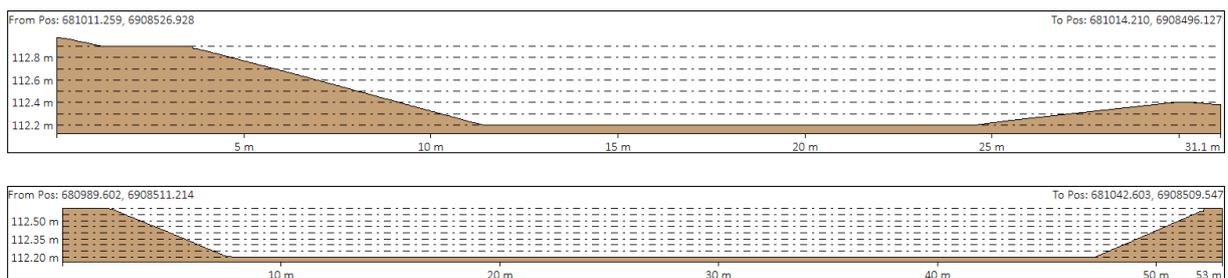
profil en travers (N-S) en haut et en long (E-W) en bas
